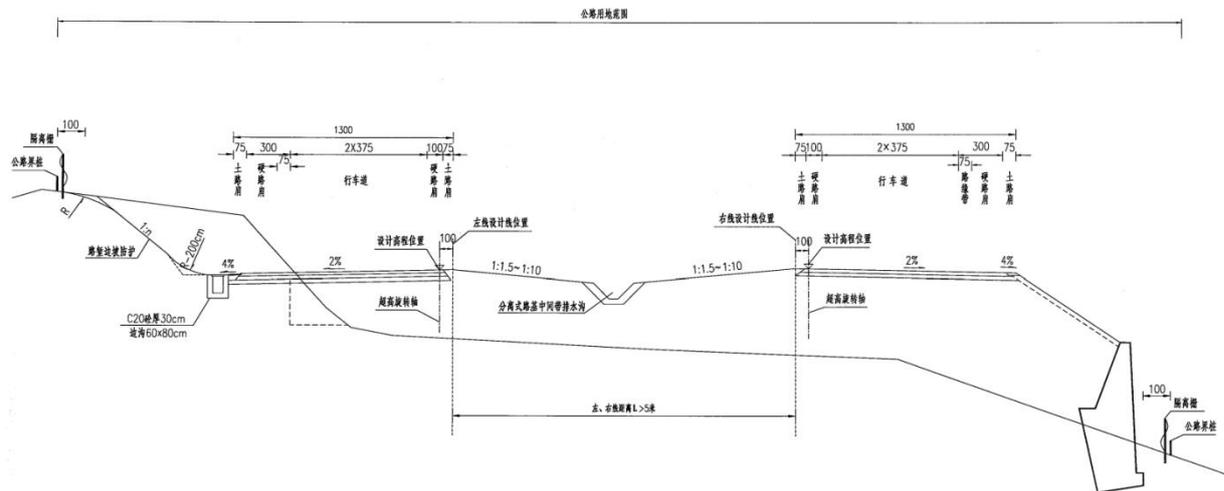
主线分离式路基标准横断面示意图（mm）
